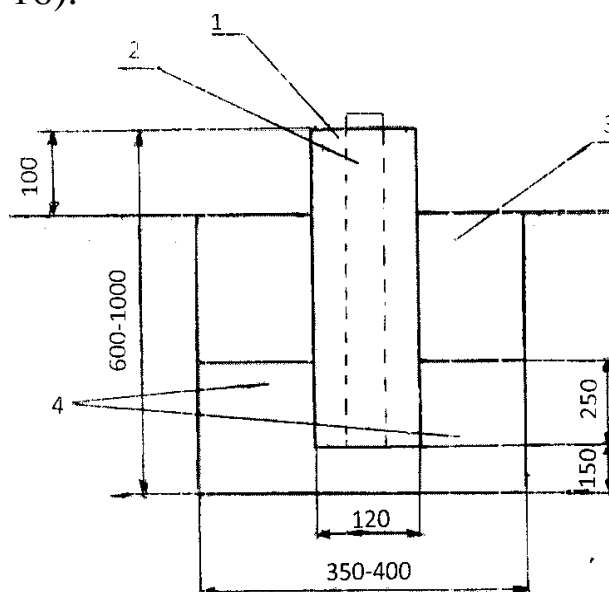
Бетонний фундамент для монтажу аркової плівкової теплиці:
